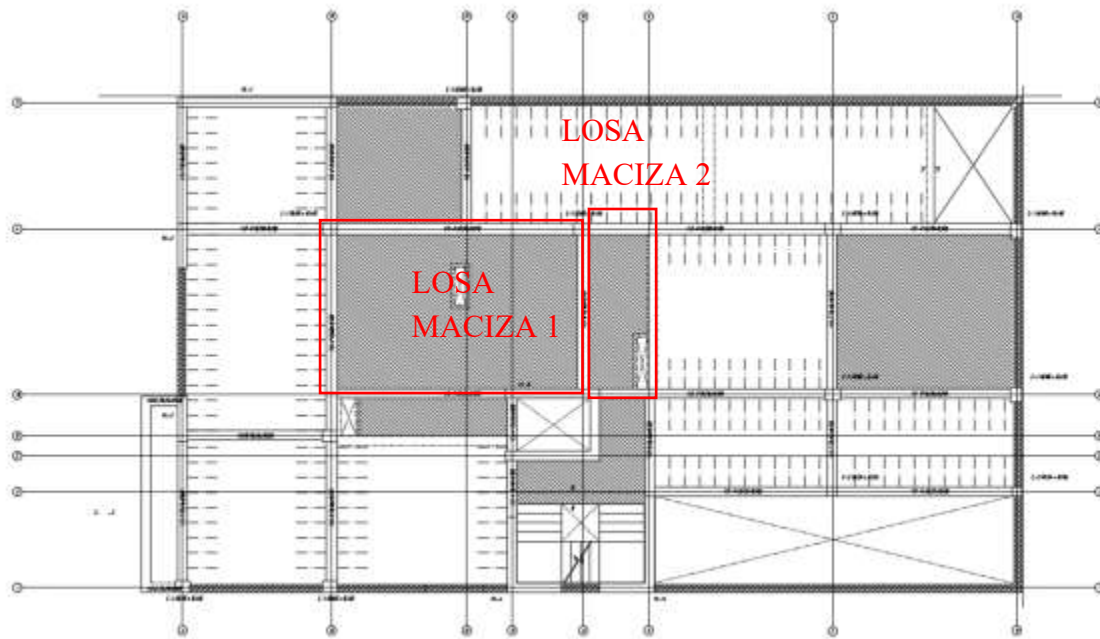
Ubicación en planta de las losas macizas a diseñar
